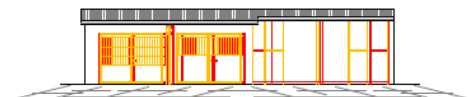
Planimetrie di confronto sovrapponendo stato di fatto e stato assentito
